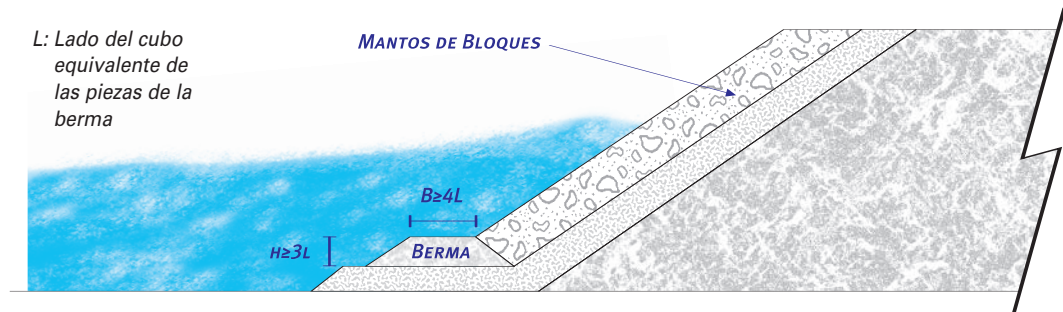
Sección de berma recomendada de apoyo de bloques a pie de talud.
